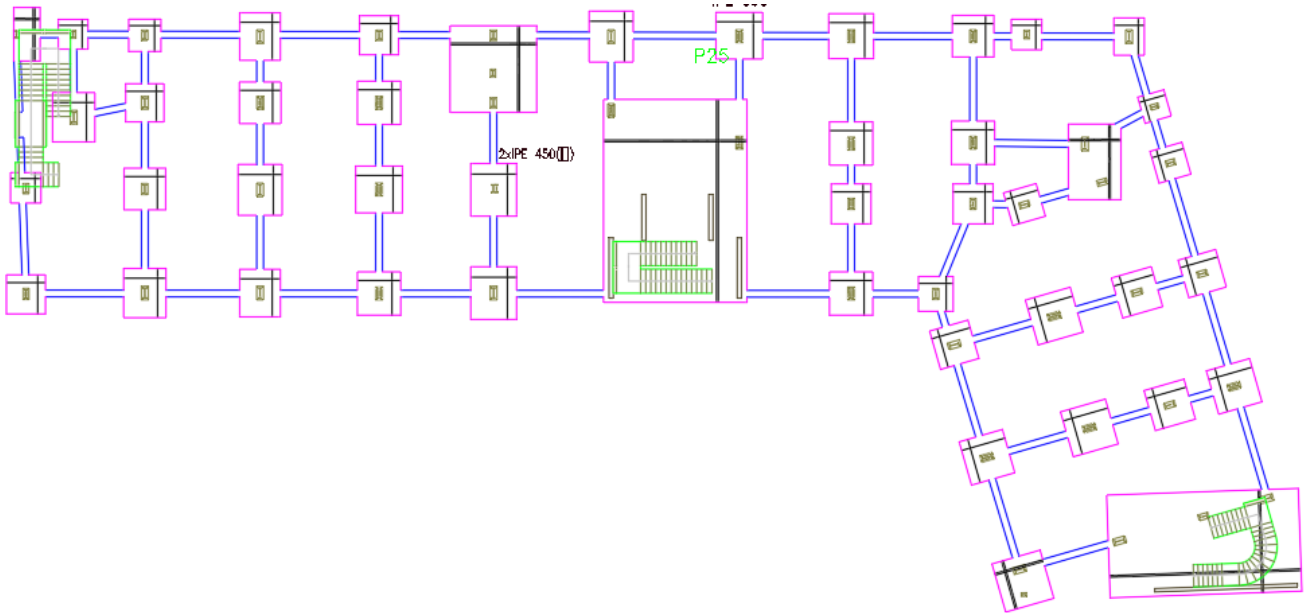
Planta de cimentación donde aparece reflejado el pilar P25
